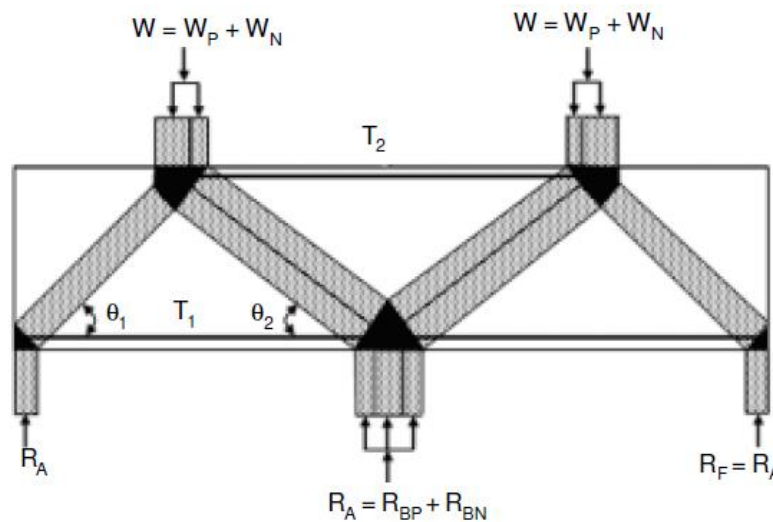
Modelo completo de treliça plástica (NAGARAJAN; PILLAI, 2009).
